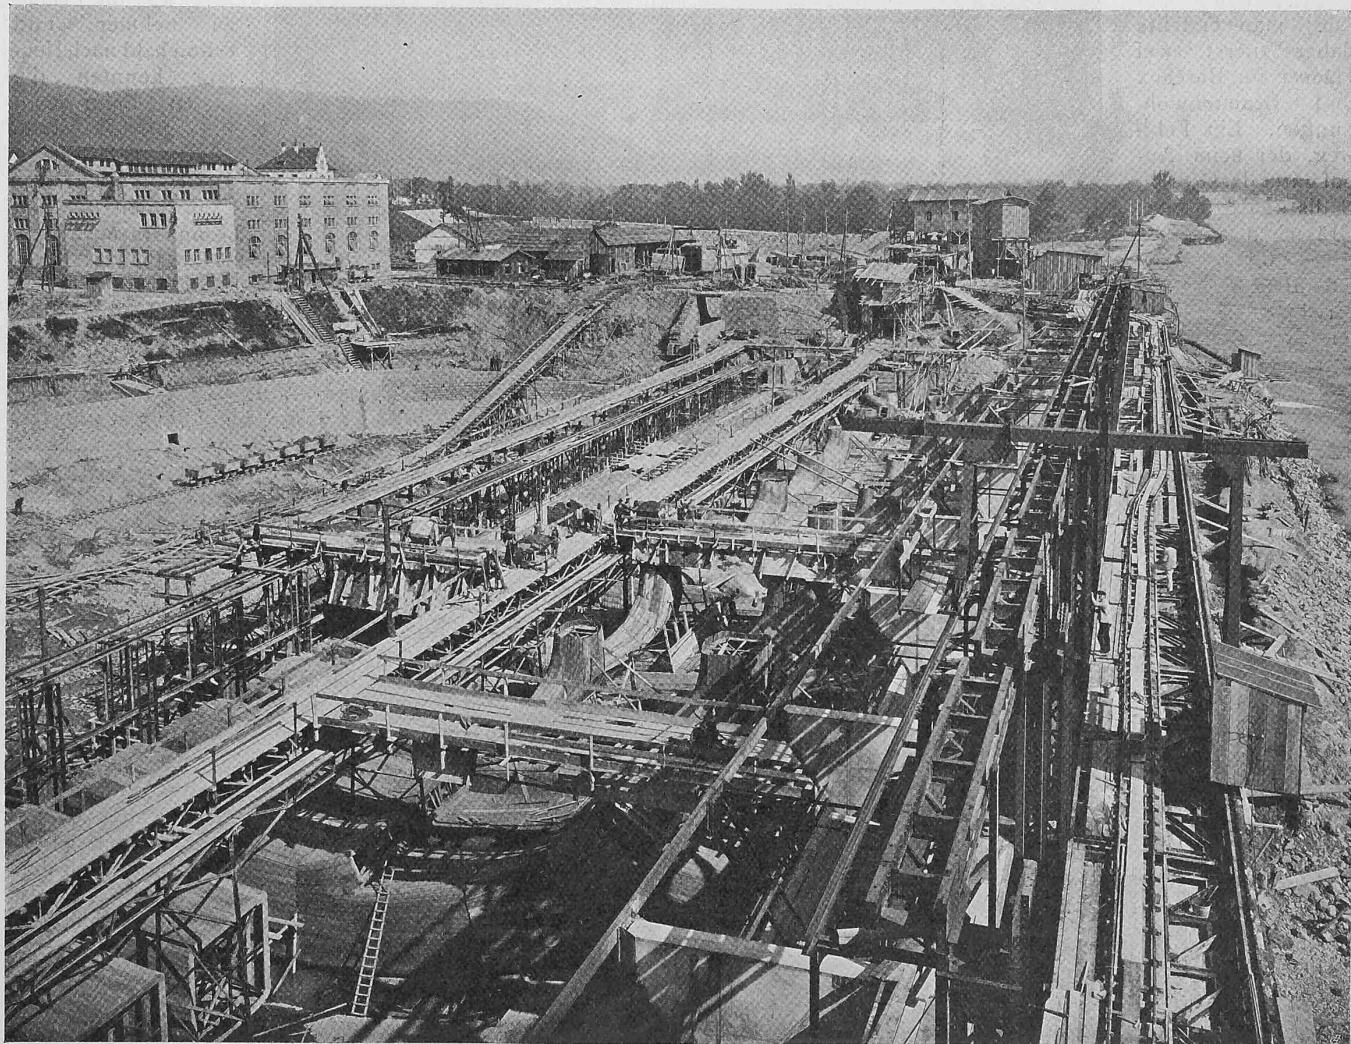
Baugrube des Unterwasserkanals, Schauung zur Betonierung der Turbinen-Saugrohre (26. IX. 1910).
